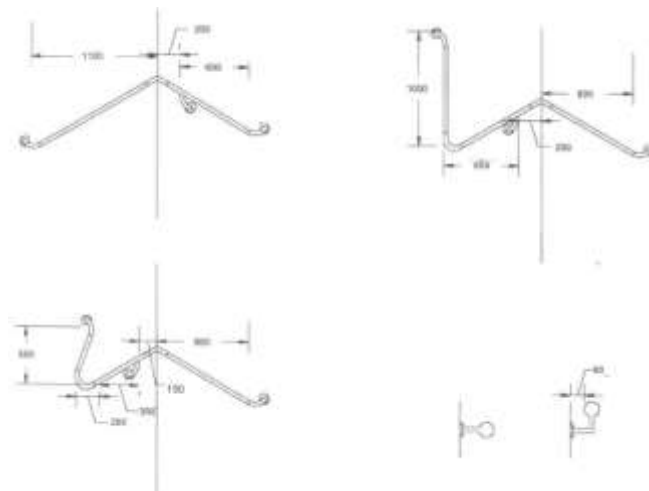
Barras de apoyo. Forma y dimensiones. Lavabo. (Dimensiones en mm)
